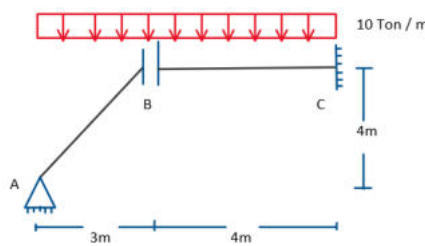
Sistema real pórtico con biela interna y columna inclinada.
